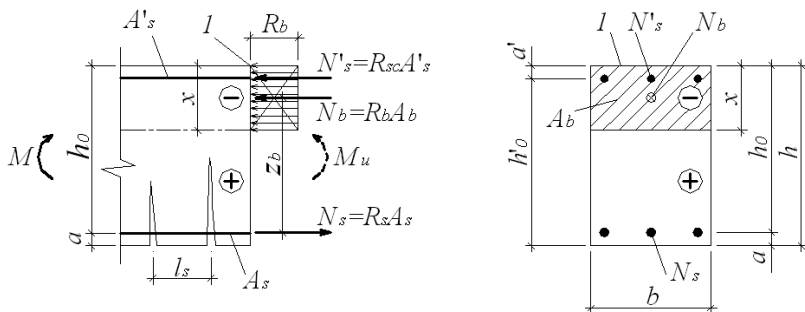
Схема усилий и эпюра напряжений в поперечном прямоугольном сечении изгибаемого железобетонного элемента
